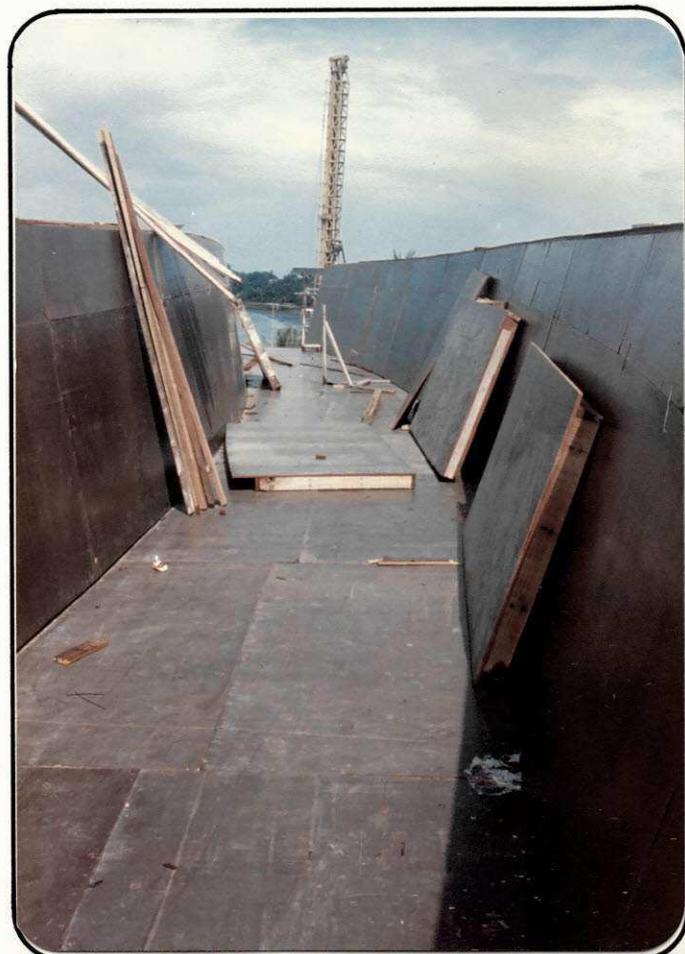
Confecção de fôrmas da viga unice lular do Ramo Ci dade, em madeirit plastificado.
